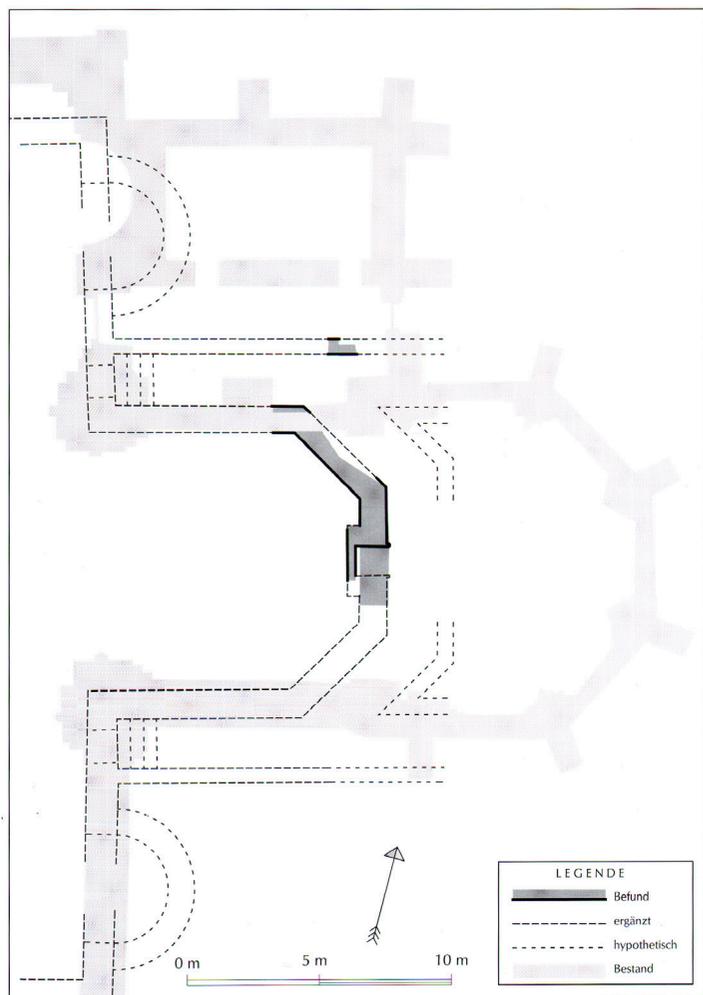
Minden, Dom. Grabungsbefunde und Grundrissrekonstruktion der Ostteile mit Polygonchor nach Ellger.
